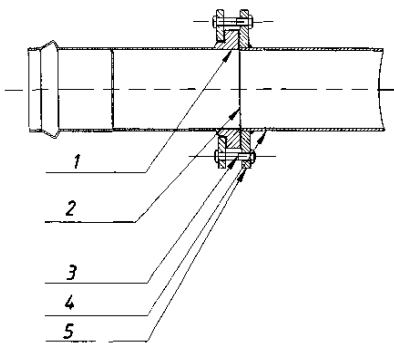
Фланцевое соединение (ФС ПП) трубопровода из НПВХ и стального трубопровода с помощью патрубка раструбного из НПВХ и металлического фланца: 1 – патрубок из НПВХ, раструбный и с металлическим фланцем; 2 – резиновая прокладка; 3 – соединительный болт; 4 – стальной трубопровод; 5 – фланец стальной плоский приварной
